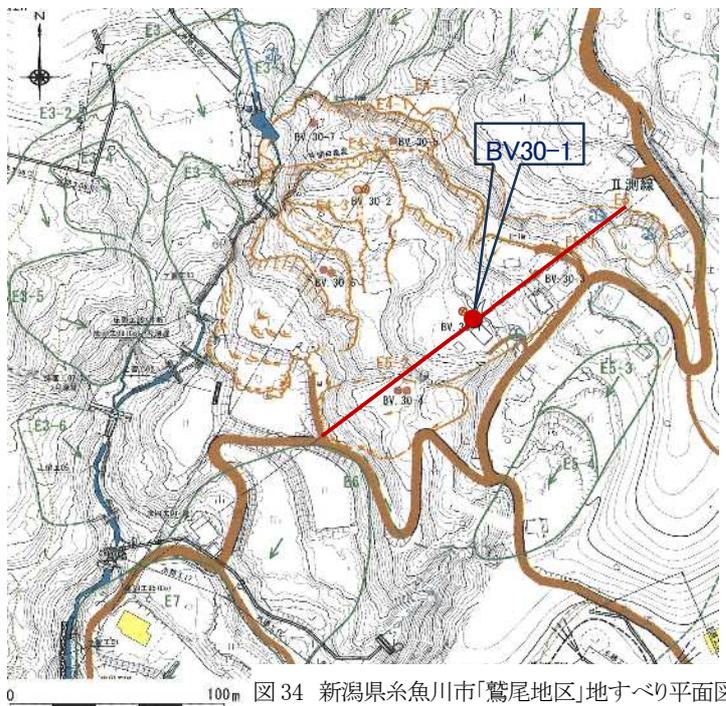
新潟県糸魚川市「鷺尾地区」地すべり平面図
